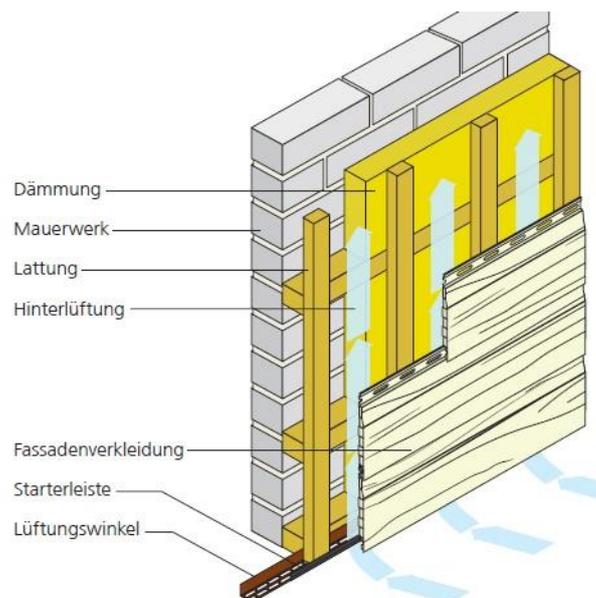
Unterkonstruktion mit einlagiger Dämmung [29]
